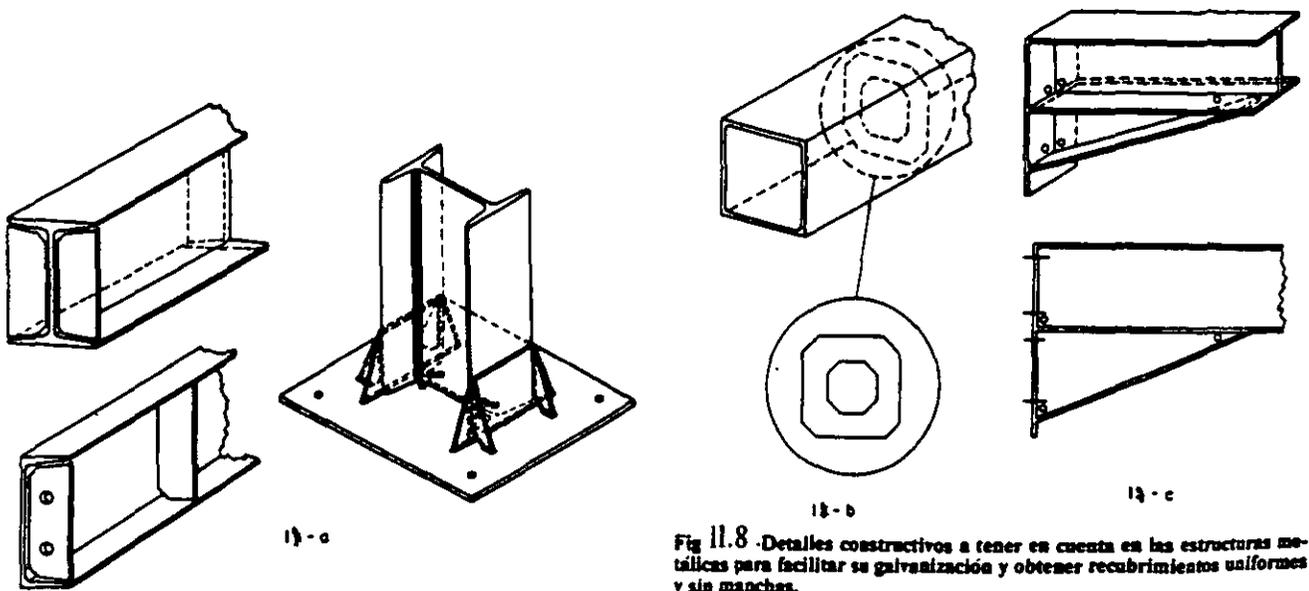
Detalles constructivos a tener en cuenta en las estructuras metálicas para facilitar su galvanización y obtener recubrimientos uniformes y sin manchas.
